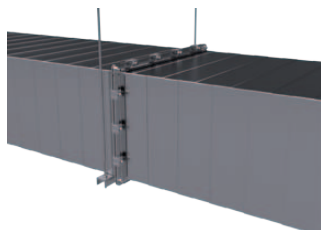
Rohové styky desek jsou spojeny požárními vruty Fire Screw
